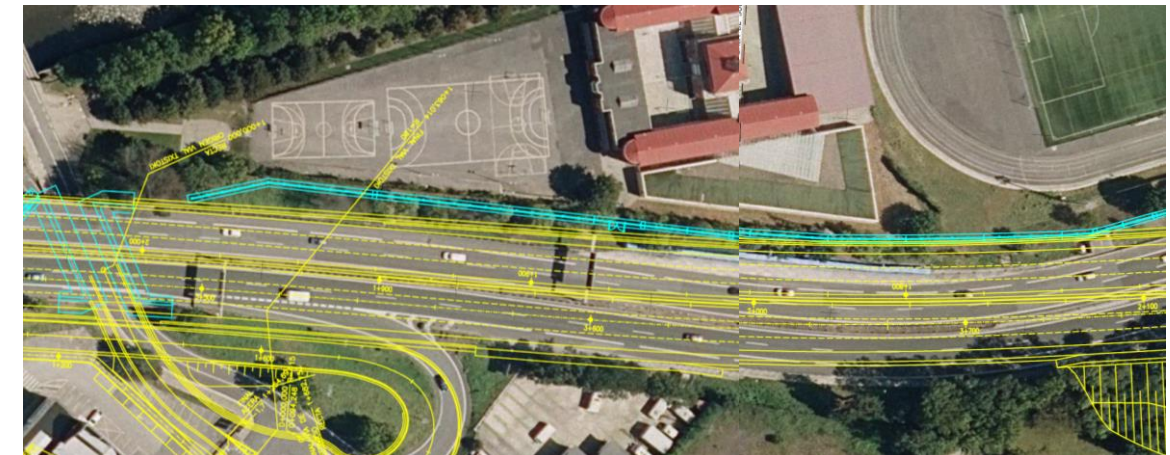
Planta del Proyecto en la zona de la Ikastola
